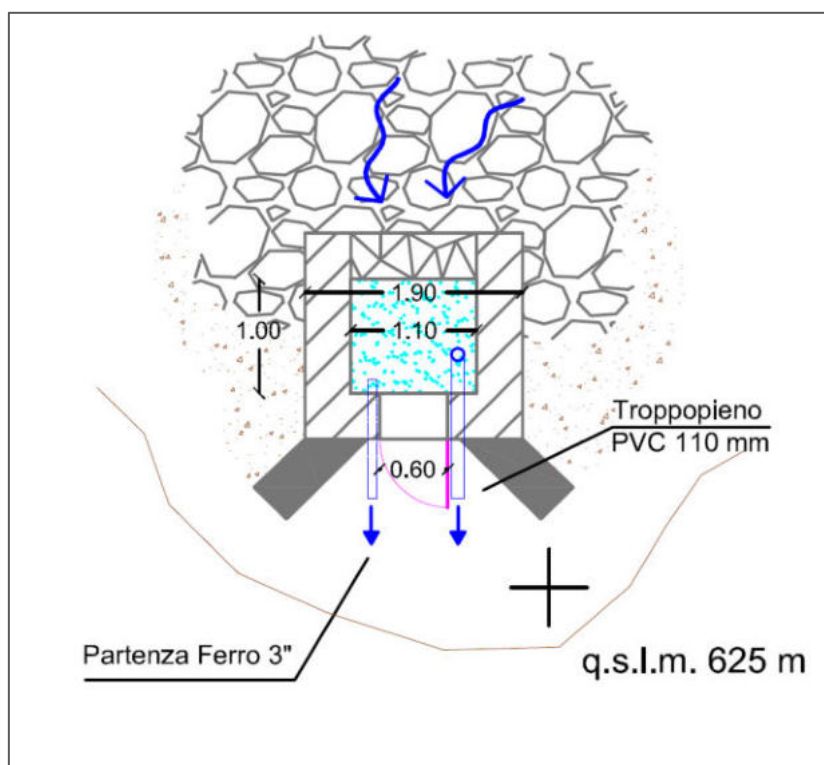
Pianta e Prospetto frontale Sorgente Cerretoli
